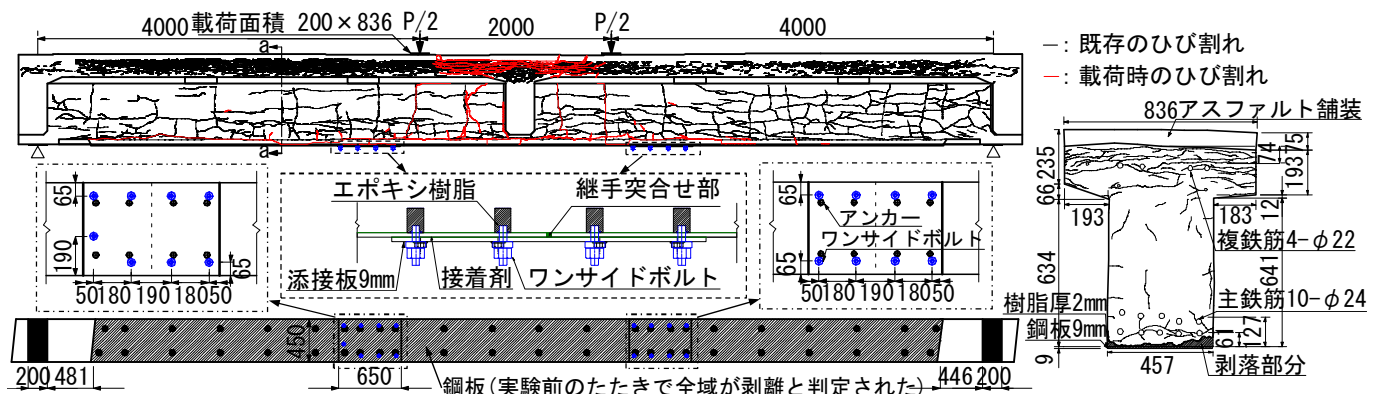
供試体 S4 の耐力試験前後の外観状況（供試体側面のひび割れ状況と鋼板の剥離状況） 図-2 耐力試験後の切断面（a-a）
